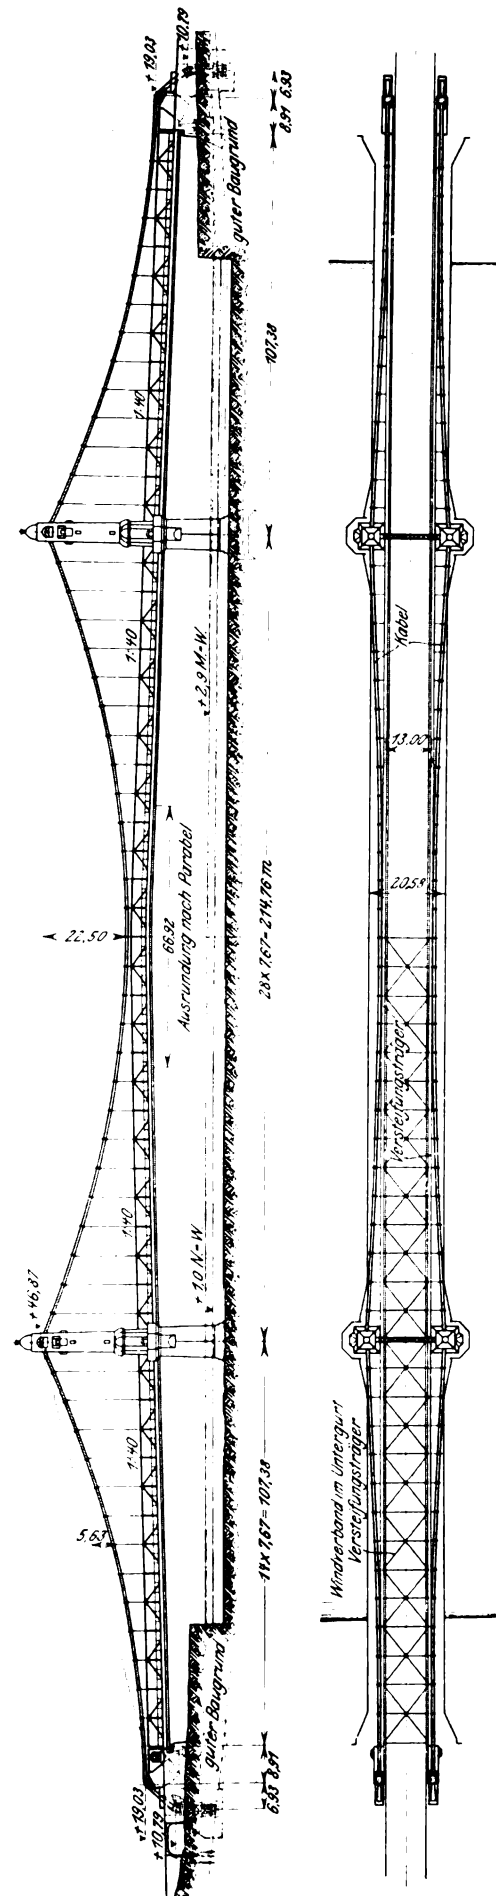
und 27. Aufbau und Grundriss.
